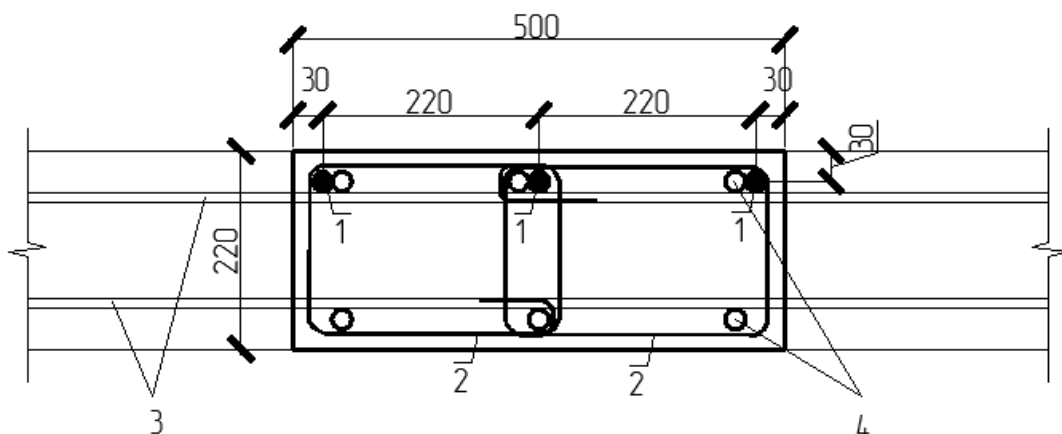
Армювання ригелю на приопорних ділянках, 1 – 3d12 A500; 2 – d8 A240, кроком 100 мм; 3 – Поперечна арматура; 5 – Поздовжня арматура
